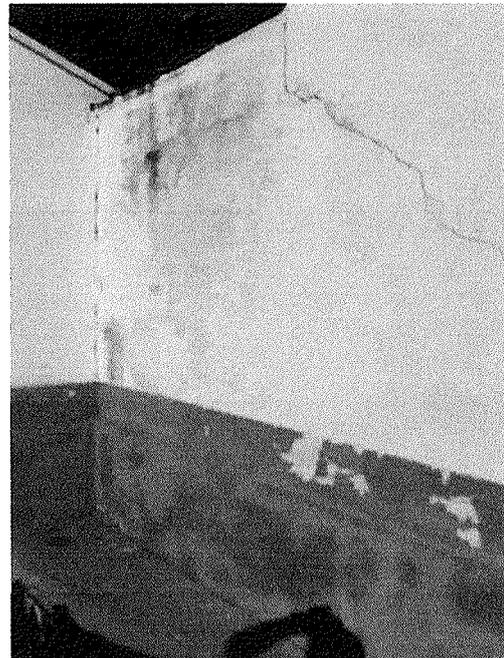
Trincas, infiltração e tinta descascando na parede do pátio
